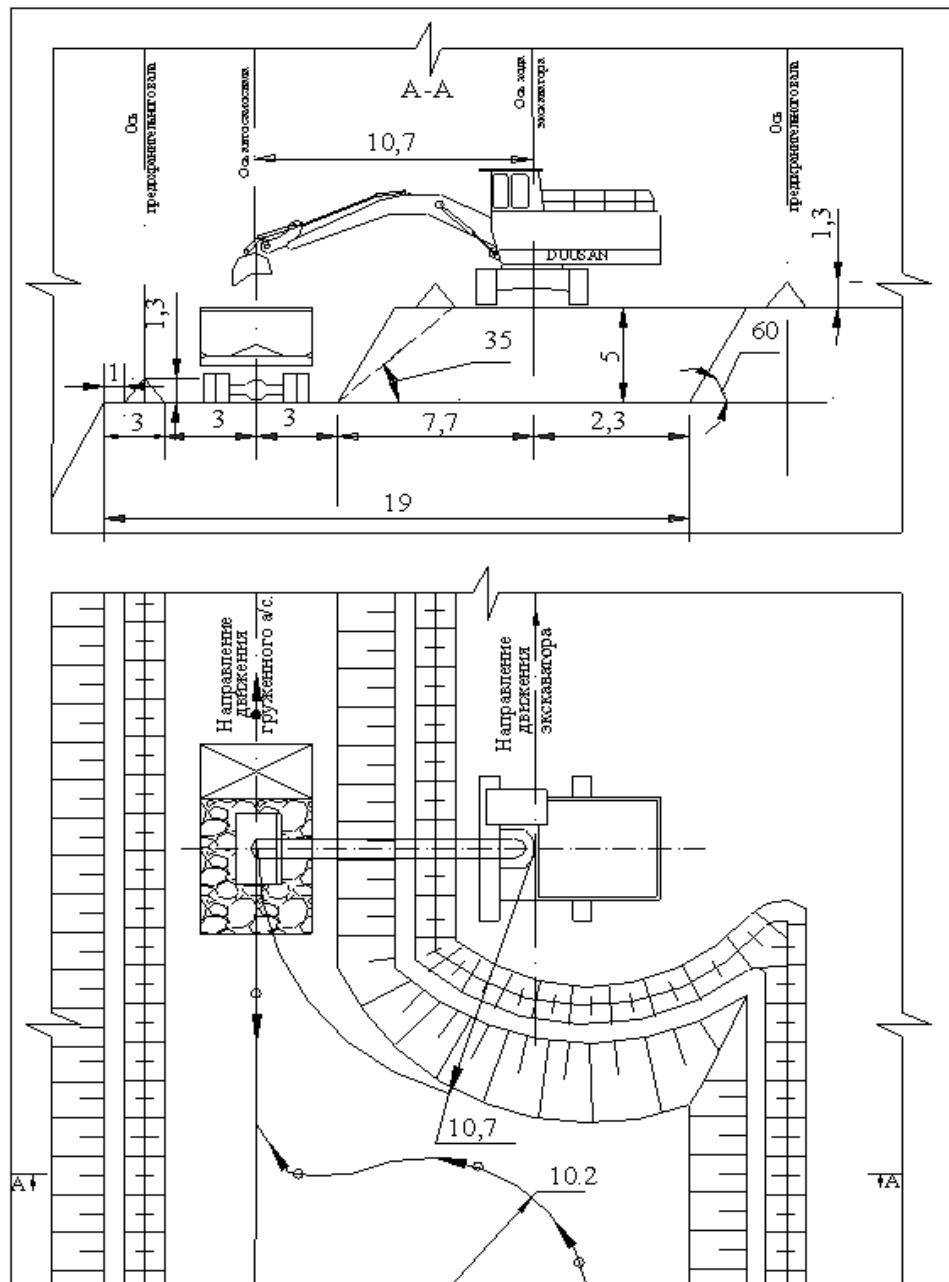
Схема к определению ширины рабочей площадки для пород, не требующих предварительного рыхления при погрузке экскаватором
